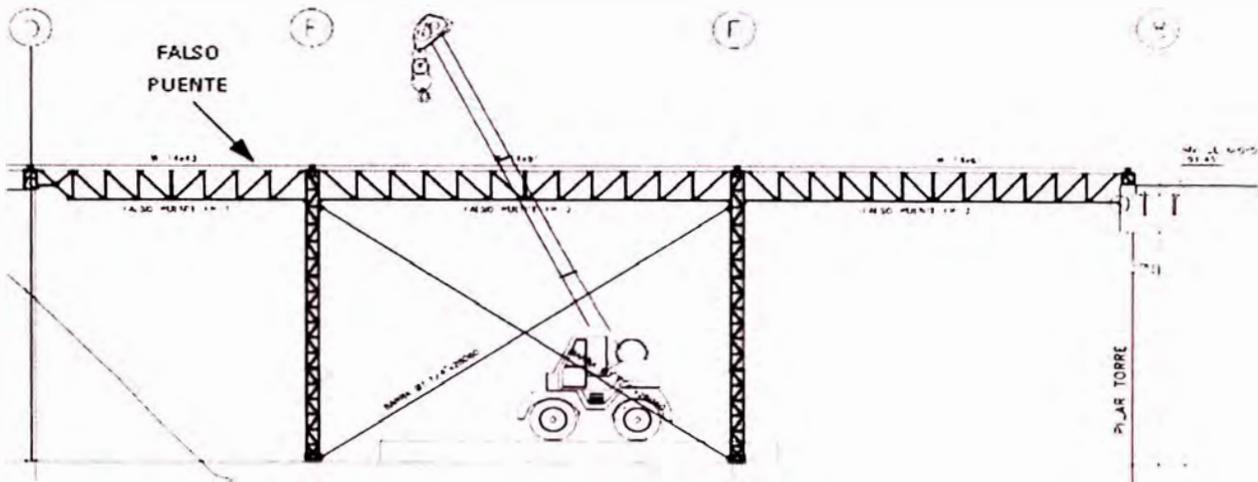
VISTA FRONTAL MONTAJE FALSO PUENTE EJES D, E, F
